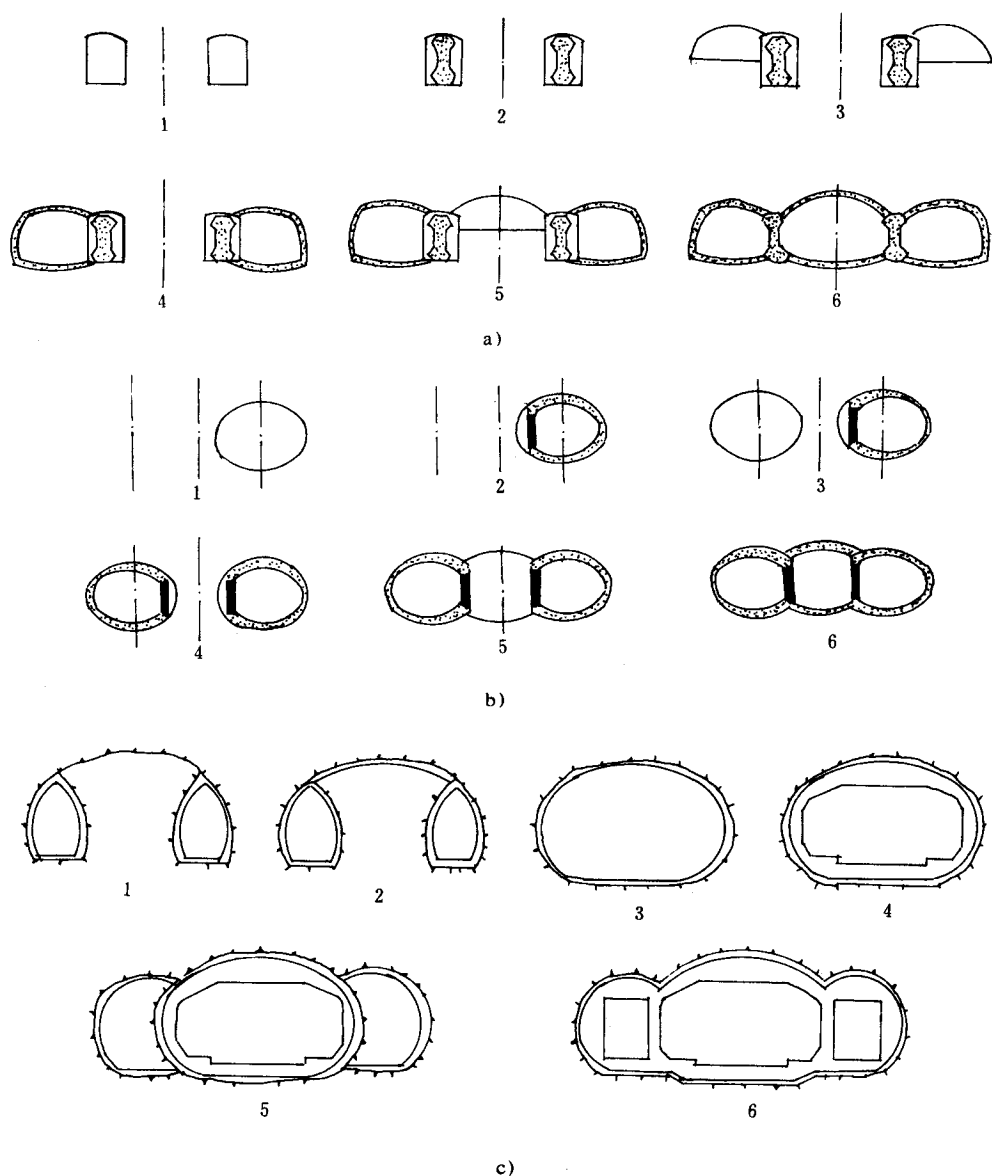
a) 柱洞法施工顺序 b) 侧洞法施工顺序 c) 中洞法施工顺序
